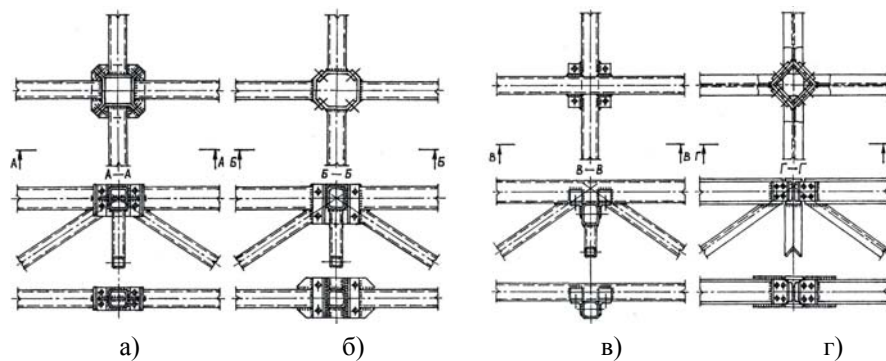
Схемы узлов пересечения стальных перекрестных ферм в виде монтажных стыков: а – на гнутых фланцах с диафрагмами жесткости; б – на гнутых фланцах без элементов жесткости; в – с поэтажным расположением пересекающихся поясов; г – на уголковых фасонках с листовыми накладками
